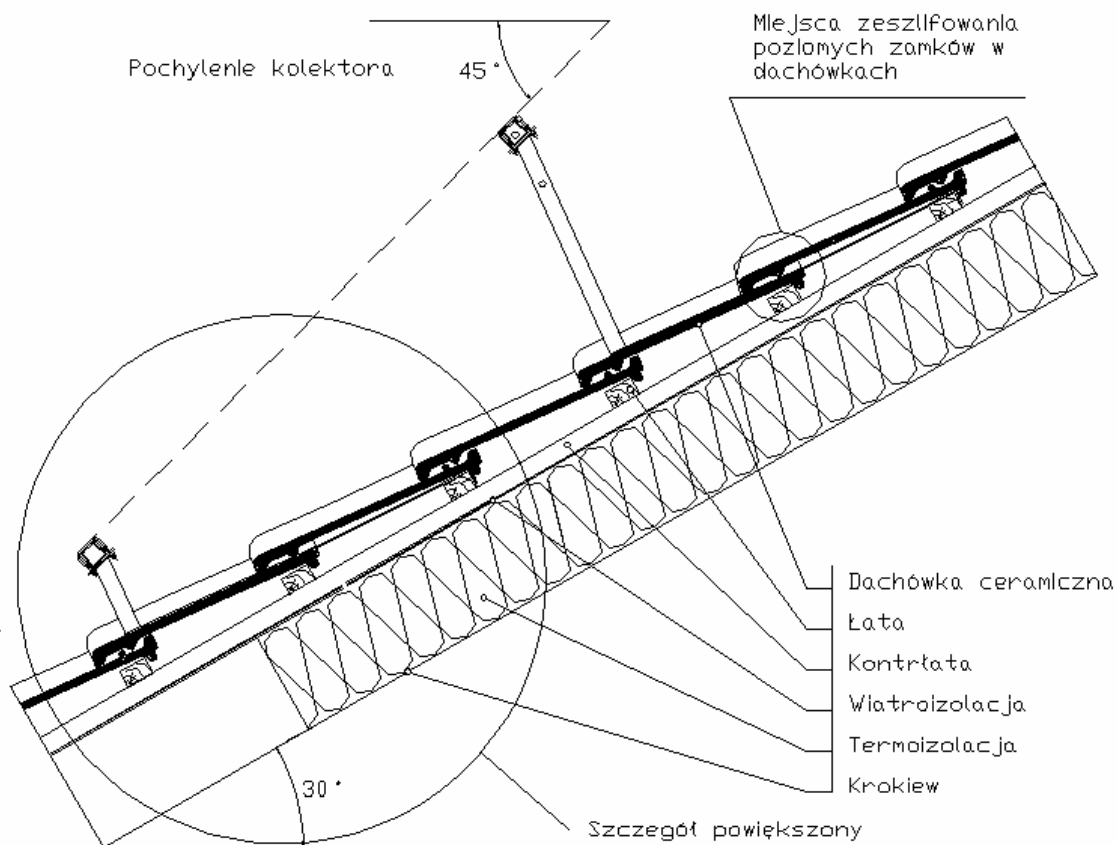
Rozmieszczenie obszarów położenia uchwytów dachowych
